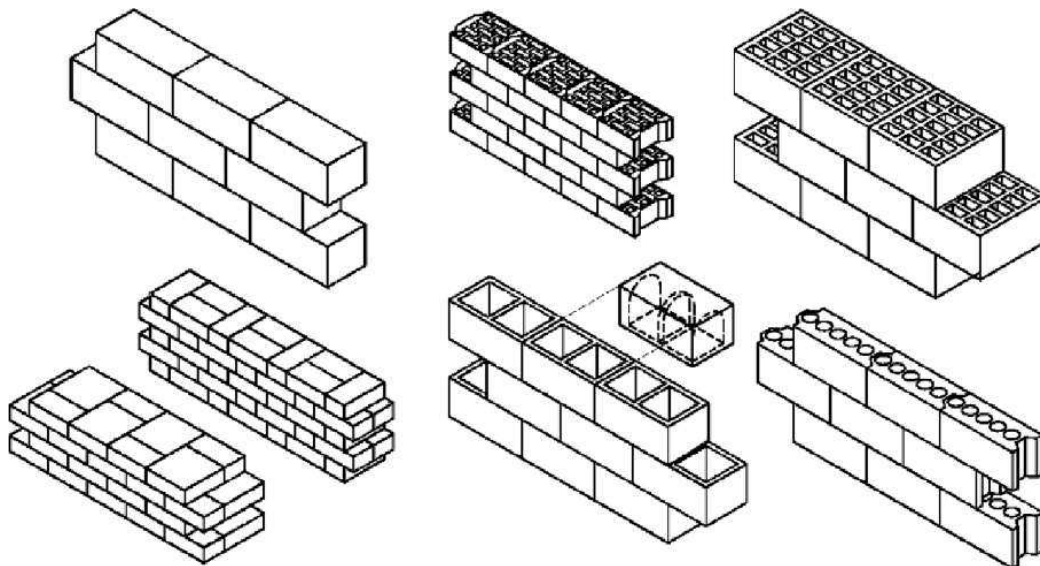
Schemi di orientamento degli elementi per muratura non armata
